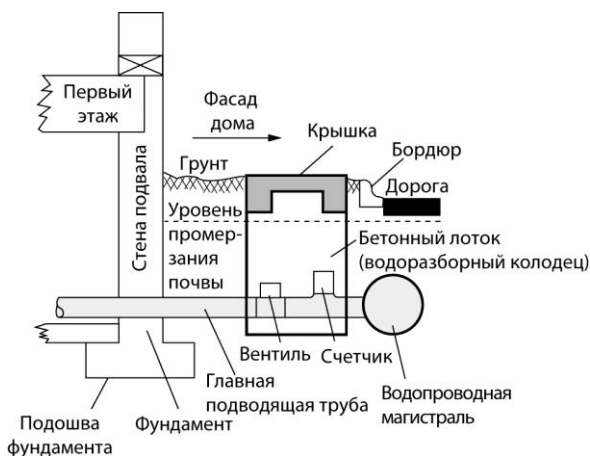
Ввод водопровода (основной подводящий трубопровод)
